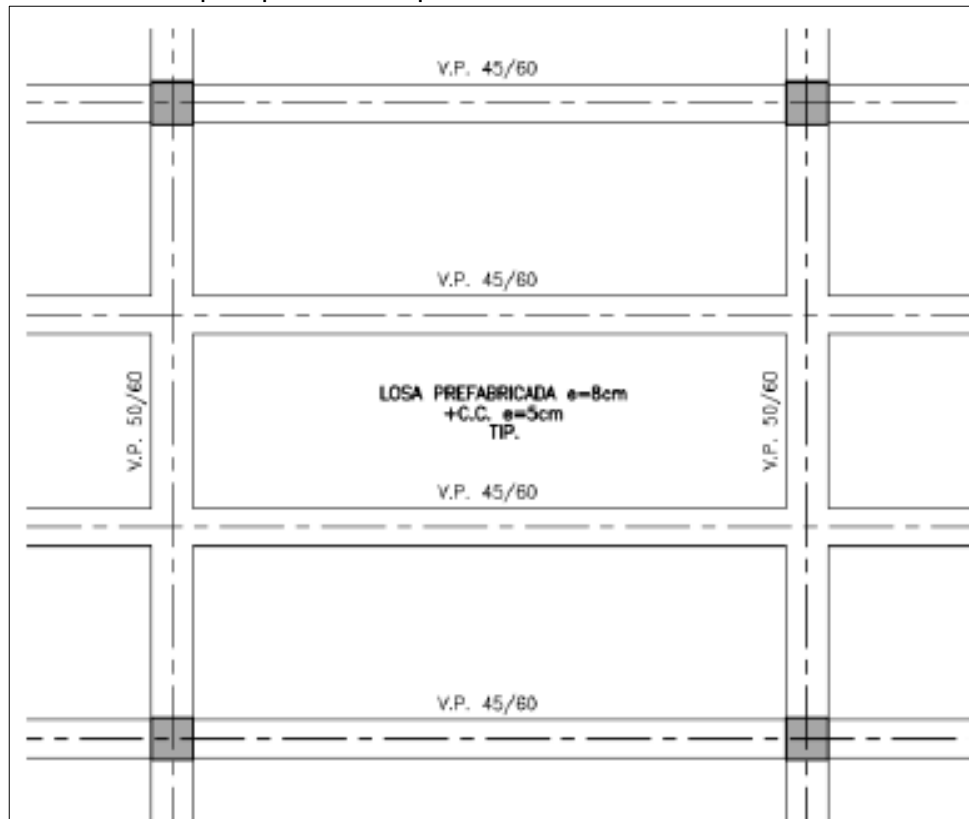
Detalle típico viga portante, losa maciza y capa de compresión.
